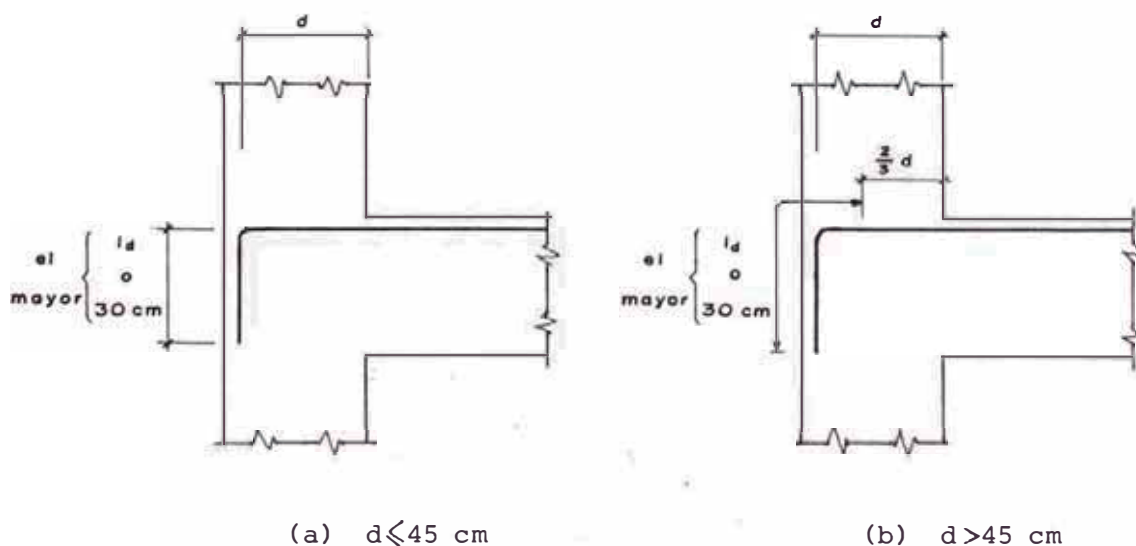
Anclaje de refuerzo en apoyos extremos de vigas
